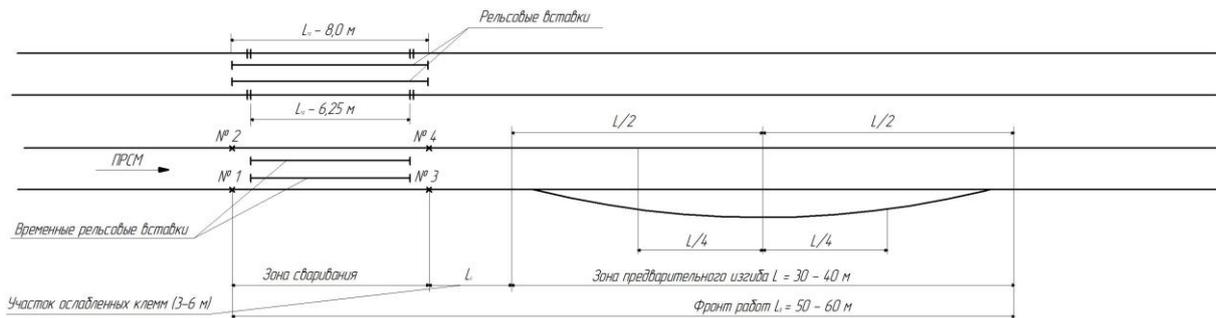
Технологическая схема места проведения сварочных работ способом предварительного изгиба рельсовой плети
